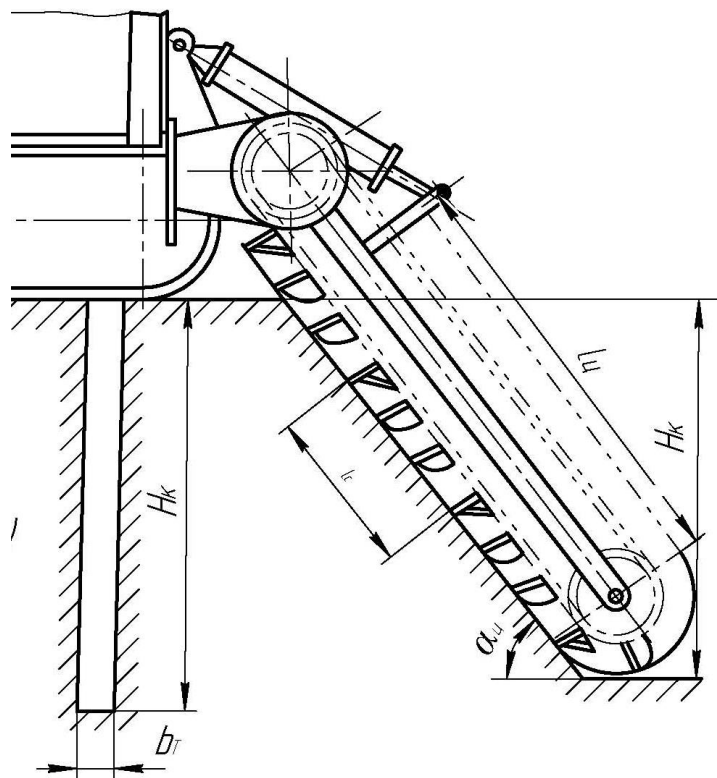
Схема машины со скребковым рабочим органом продольного копания, разрабатывающим грунт по раздельной схеме (тип 5)
